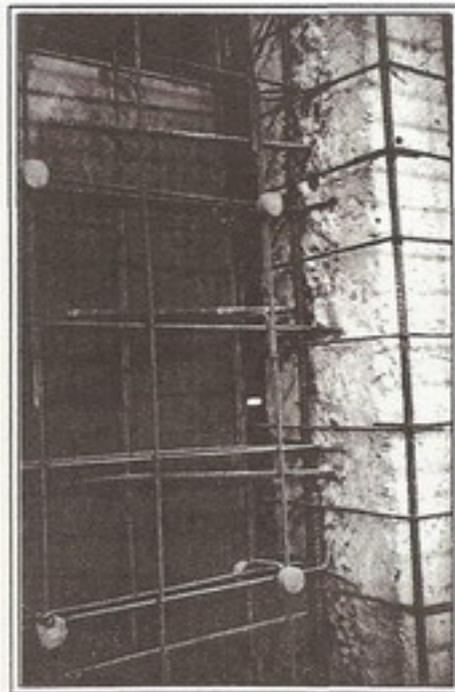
Encamisado de columnas para incrementar la capacidad resistente y para confinamiento del concreto.
